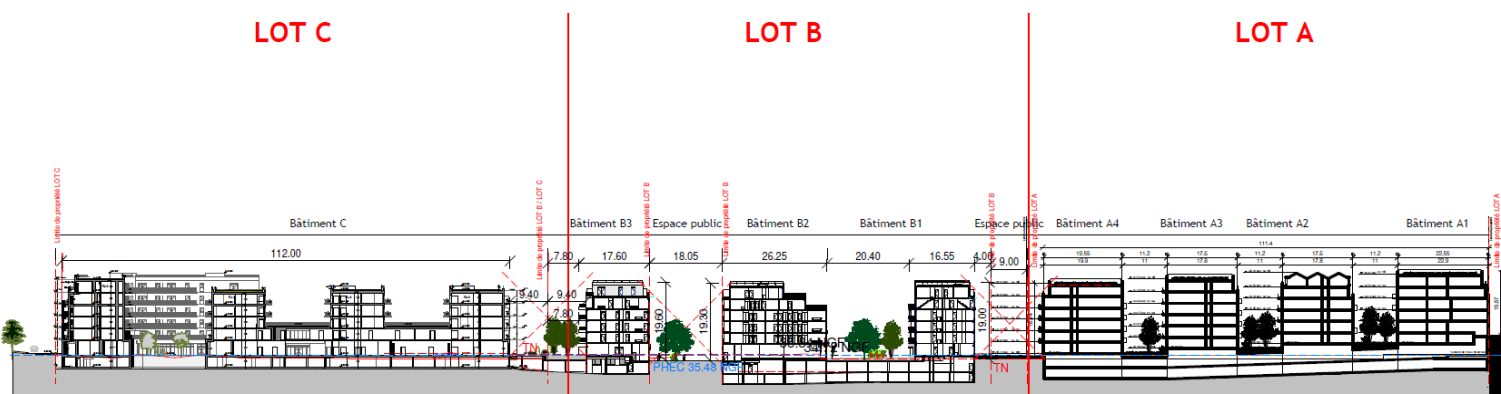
coupe longitudinale du projet qui présente les niveaux de parkings sur lesquels sont construits les bâtiments. (PC 3.1, Plan en coupe du terrain et des constructions).
